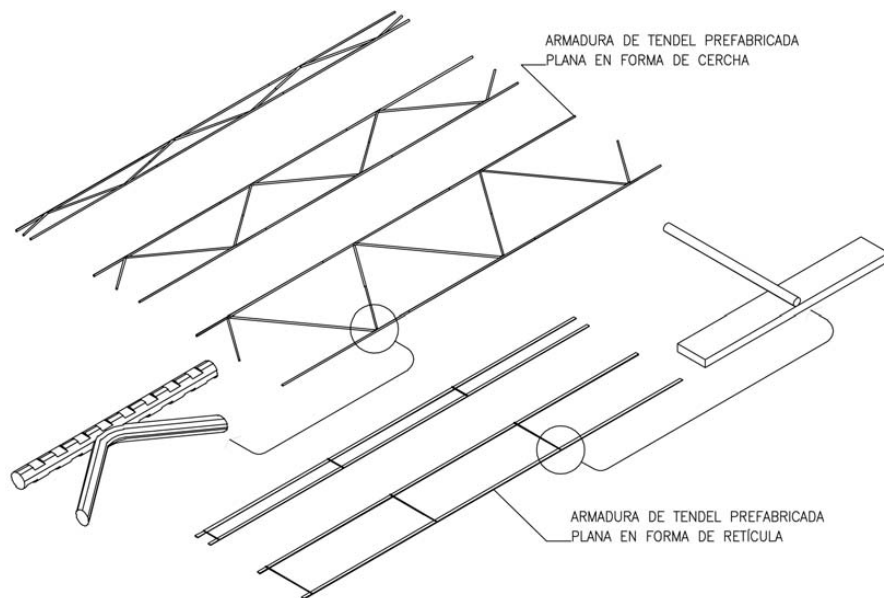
Tipologías de armaduras de tendel prefabricadas planas: en cercha y en retícula de distintos anchos y prestaciones.
